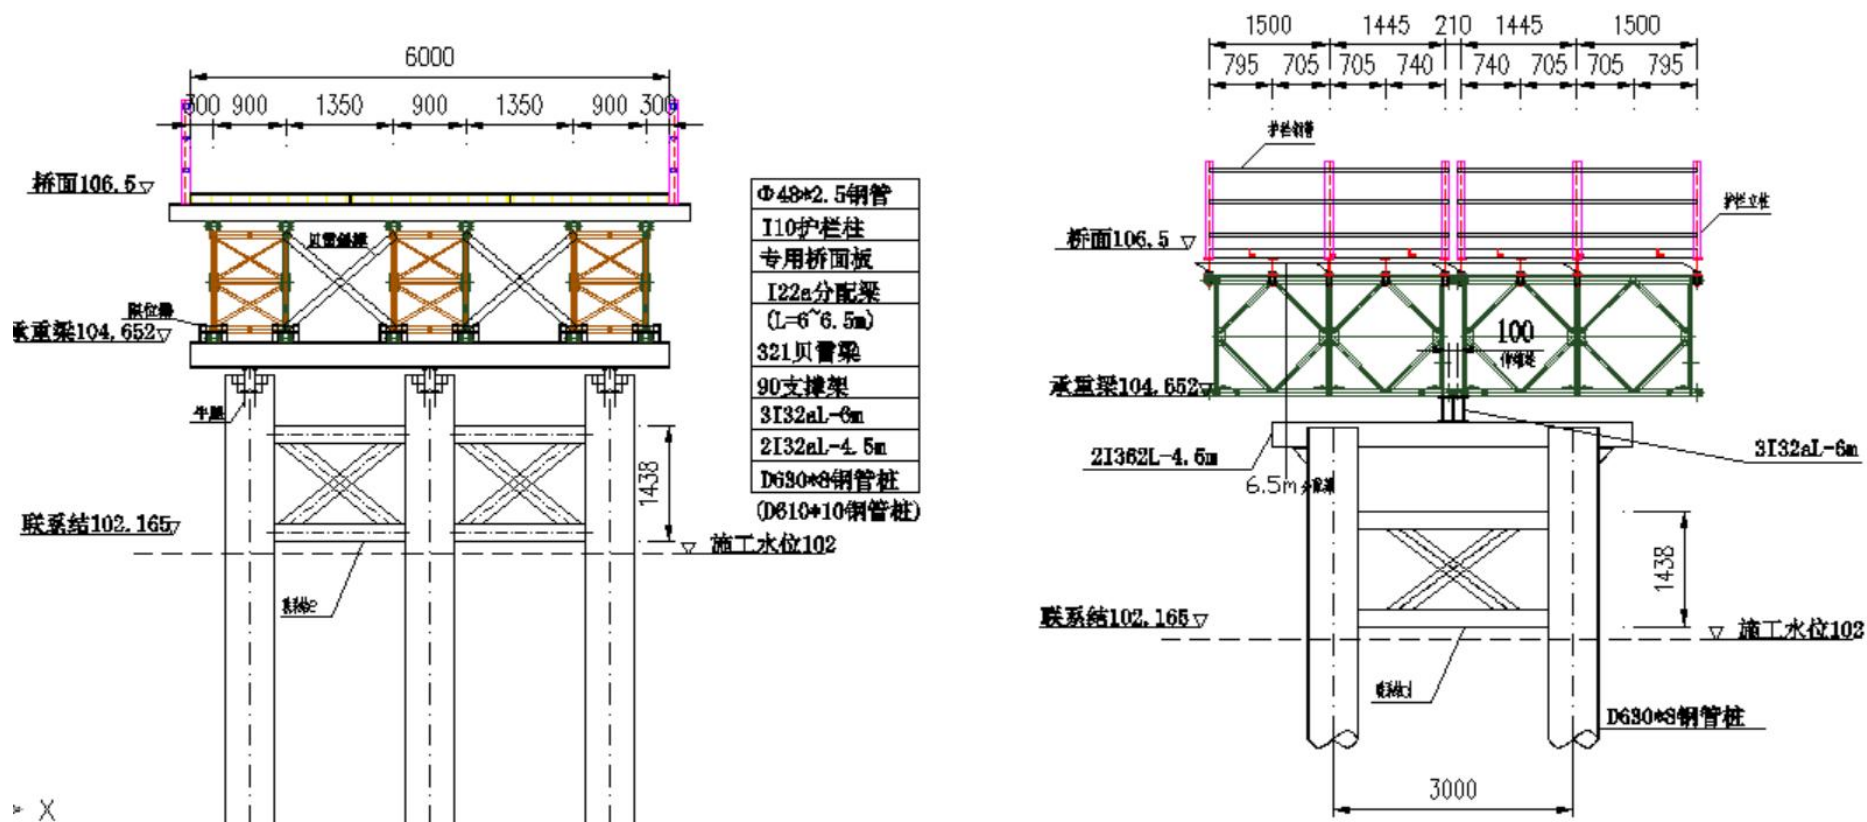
主栈桥伸缩缝墩标准结构断面布置图
